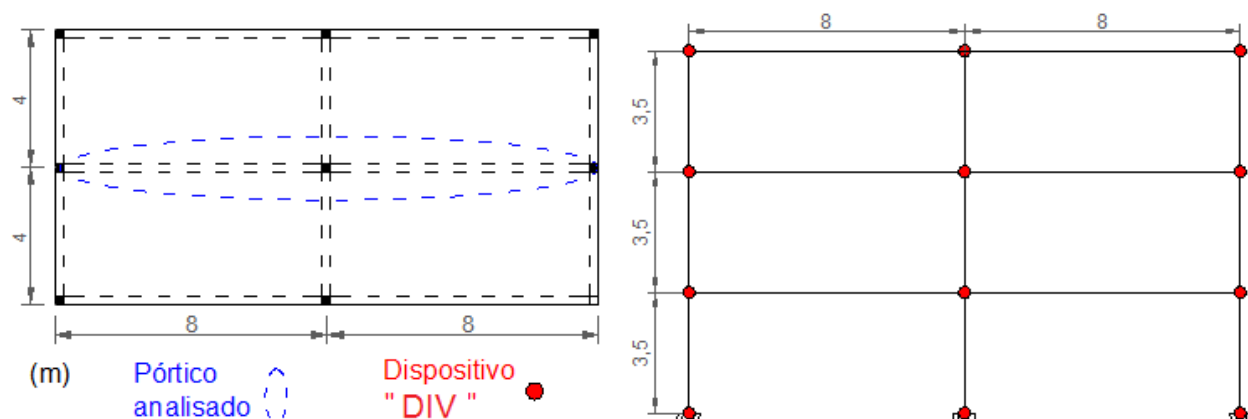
Geometria em planta e alçado do pórtico P2
